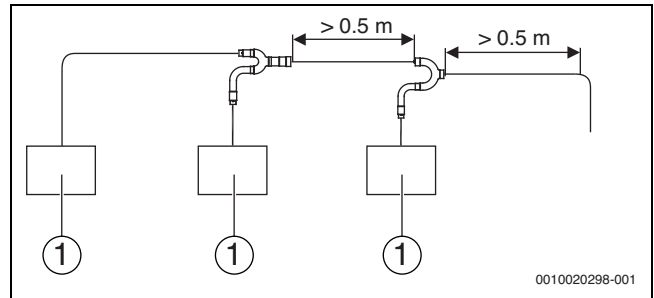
Installazione di giunti di sezione e tubi sul campo
